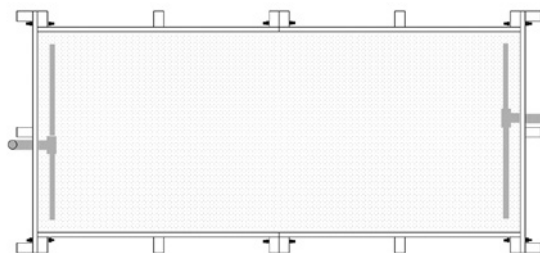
Esquema de protótipo de ZHC modular 1×2 com seis elementos estruturais de madeira.
